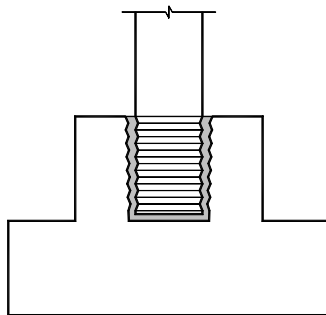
Ligação pilar-fundação em cálice - rugosidade nas faces laterais do pilar e nas faces interiores do cálice para transmitir momento por atrito do pilar para a fundação.
